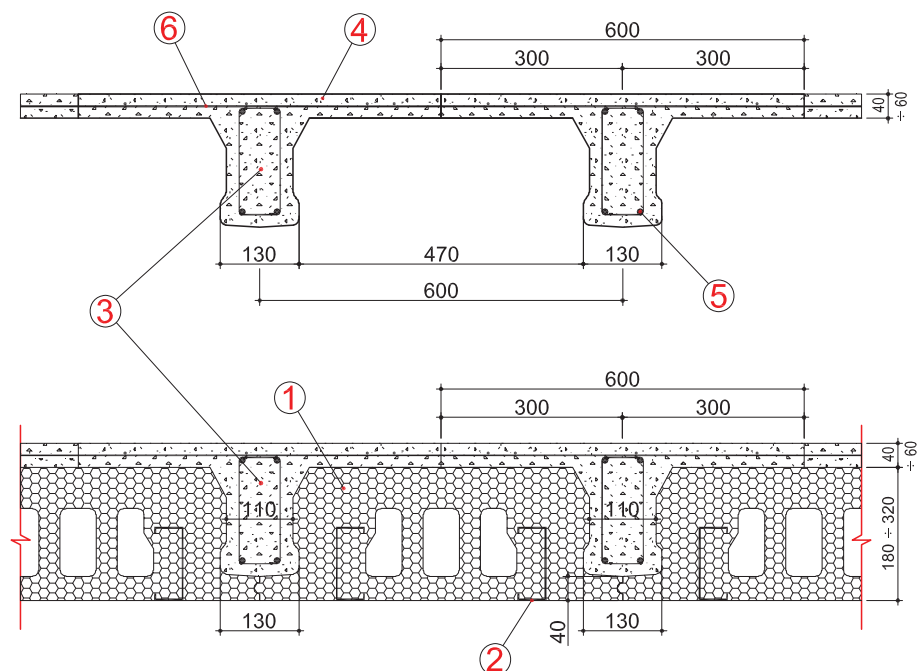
Ребристое перекрытие, созданное с использованием несъемной опалубки:
